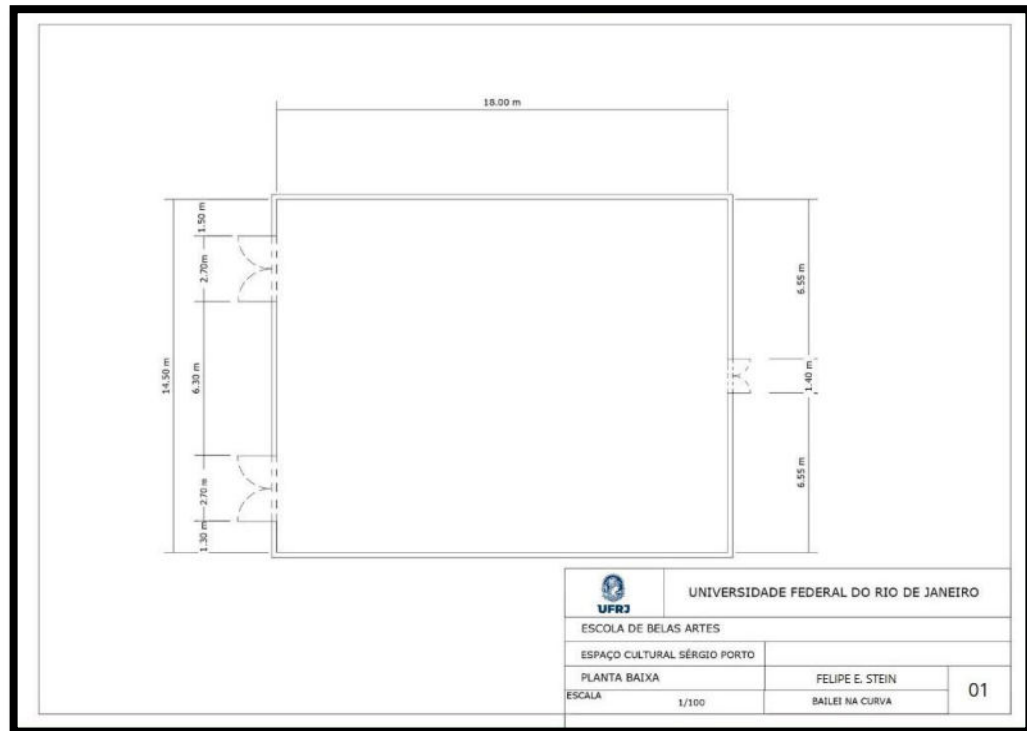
Planta baixa. Espaço Cultural Sérgio Porto.
